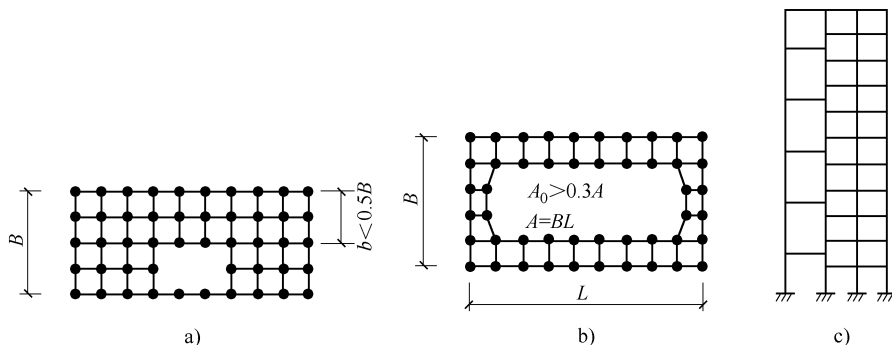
建筑结构平面的局部不连续示例（大开洞及错层）
